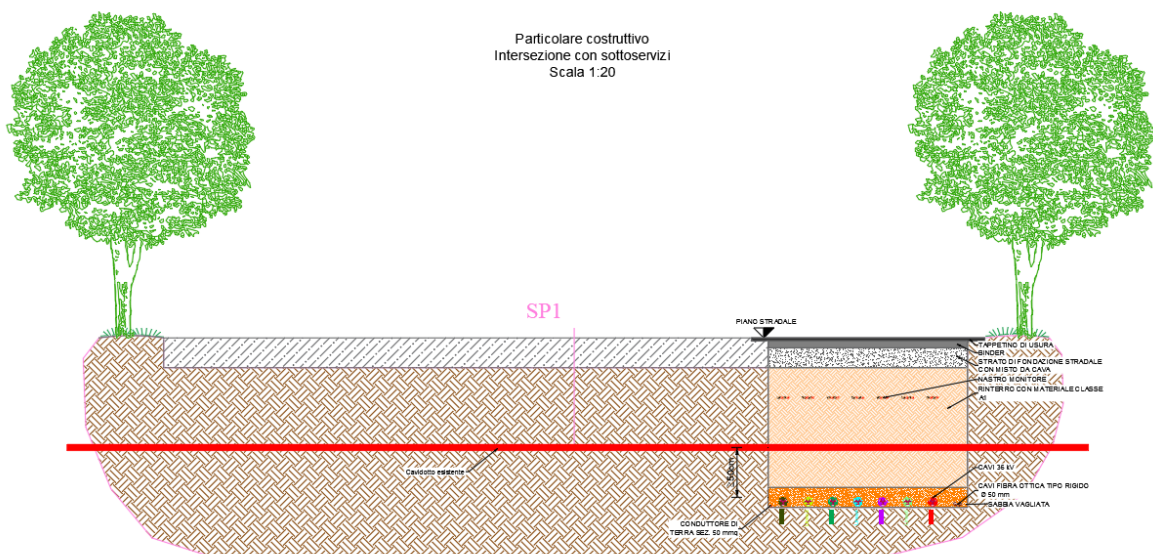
Sezione trasversale tipologica intersezione Cavidotto 36 kV con sottoservizi
